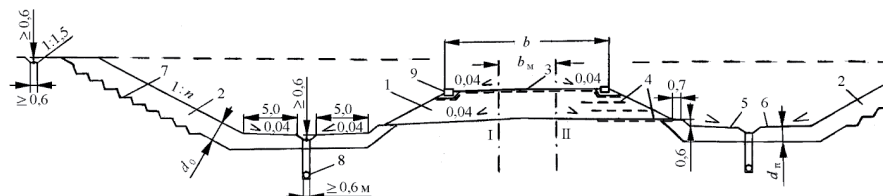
Поперечный профиль выемки глубиной до 4 м в глинистых грунтах при её разработке под насыпь:
